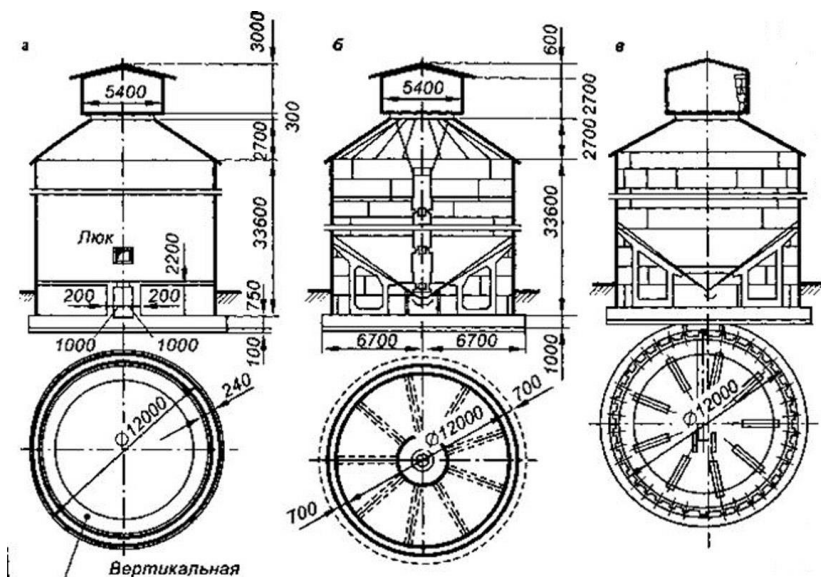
Варианты конструкций железобетонных силосов диаметром 12 м:
